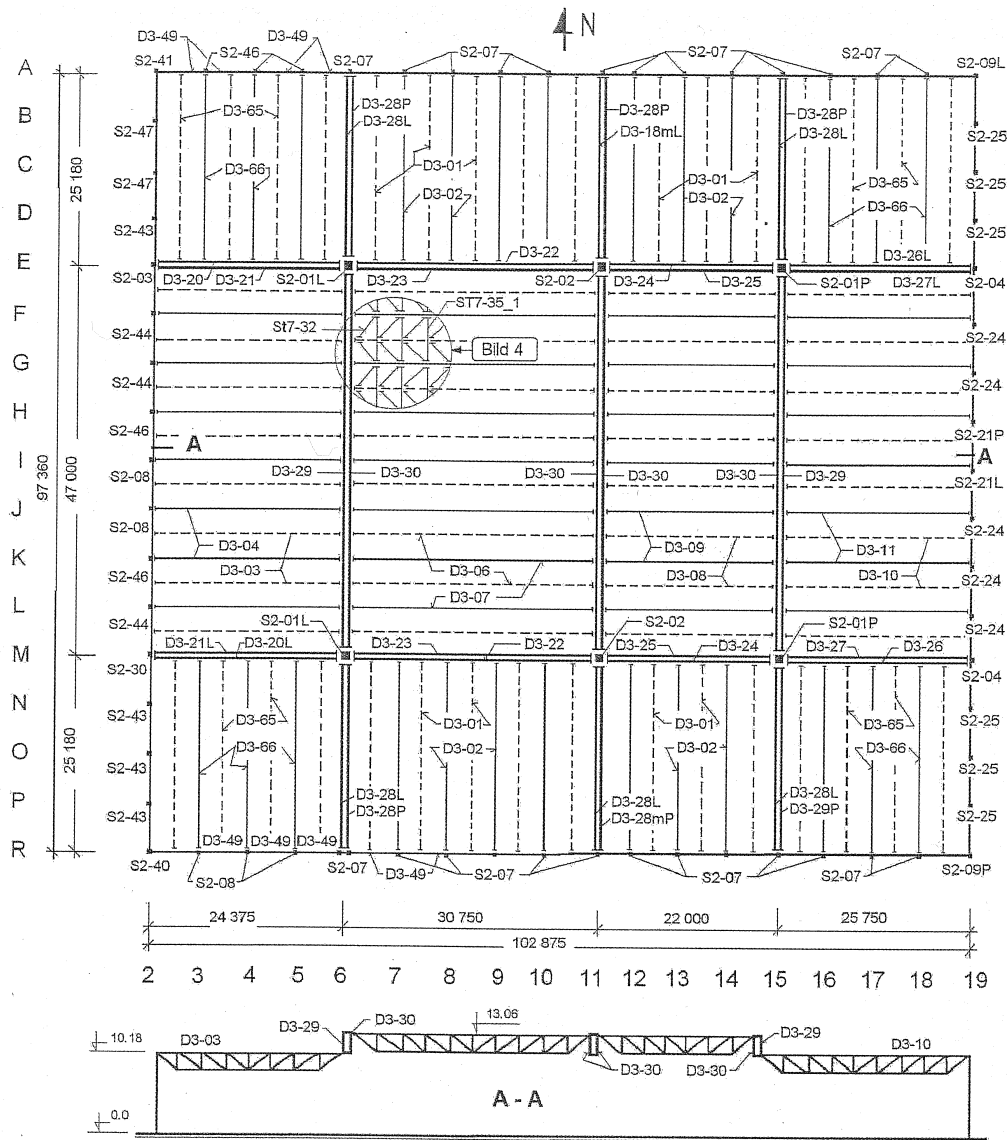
Grundriss und Aufriss der Stahlkonstruktion [AB06]
